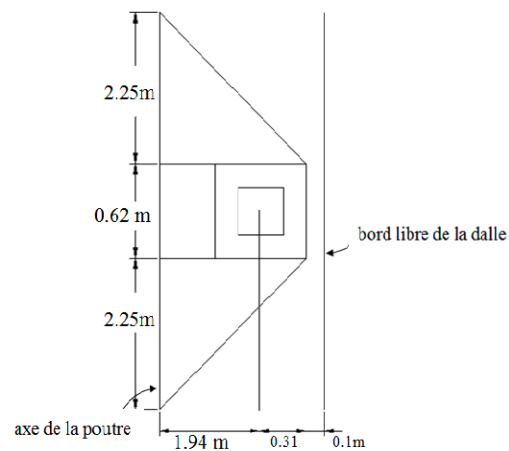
Surcharge de B_r sur la dalle d'encorbellement
